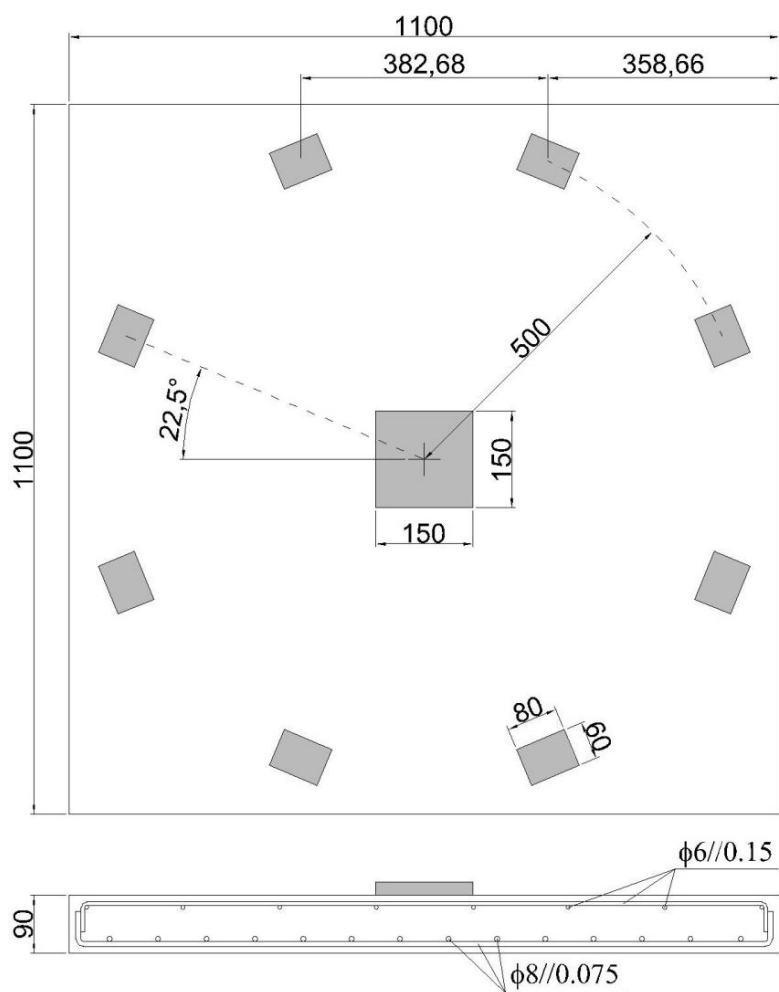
Esquema de geometria das lajes da campanha experimental (dimensões em mm)
